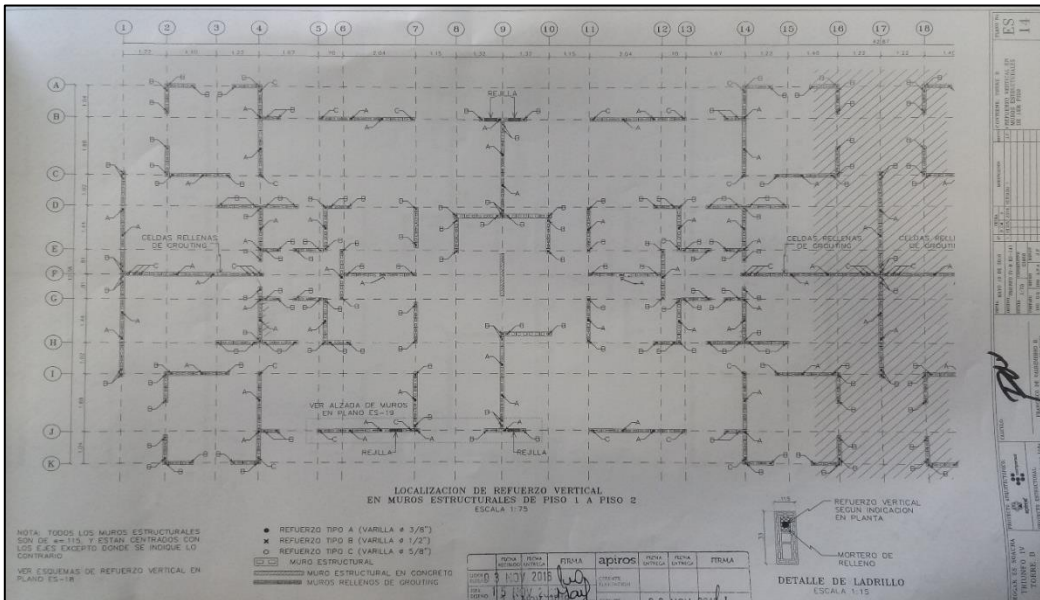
Y 67 PLANOS DE LOCALIZACIÓN DE DOVELAS PRIMER PISO
